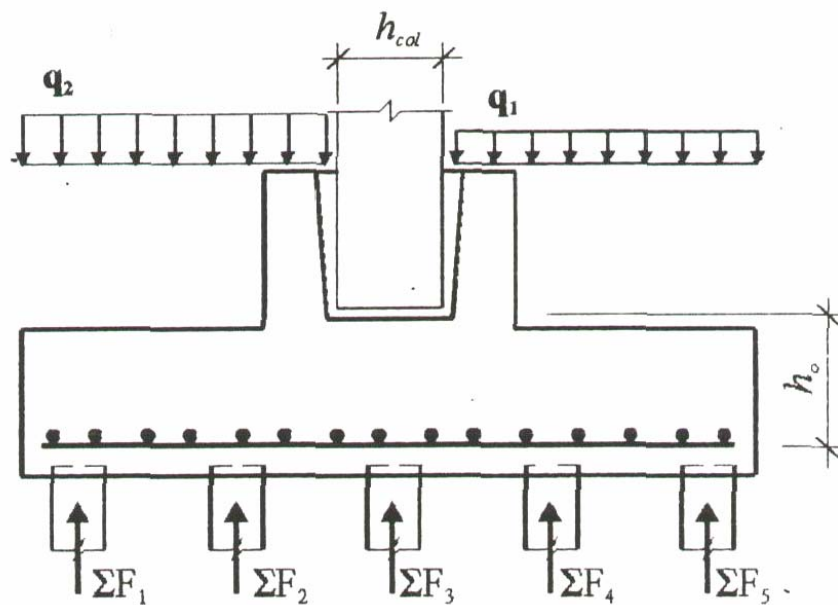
Расчетная схема при определении арматуры подошвы ростверка
